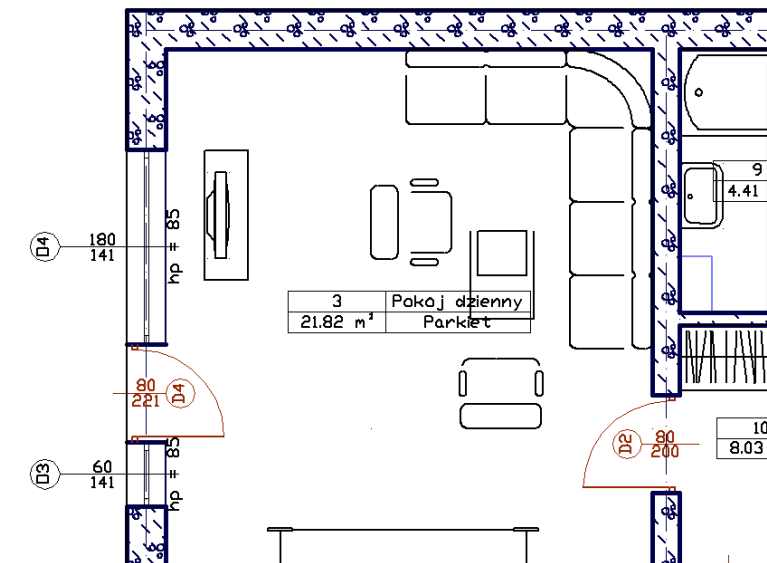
Beispiel für einen Geschossgrundriss mit eingeschalteter Anzeige der Liniendicke
